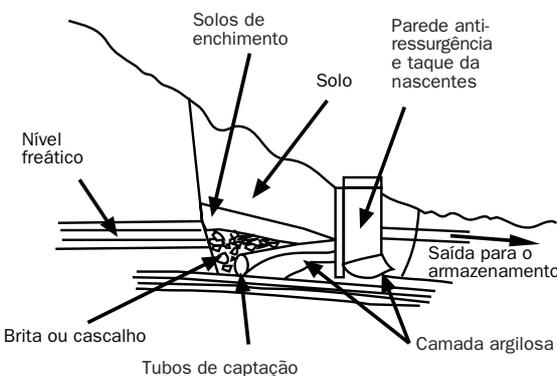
(a): Pormenores construtivos de obras de protecção de nascentes pontuais.
